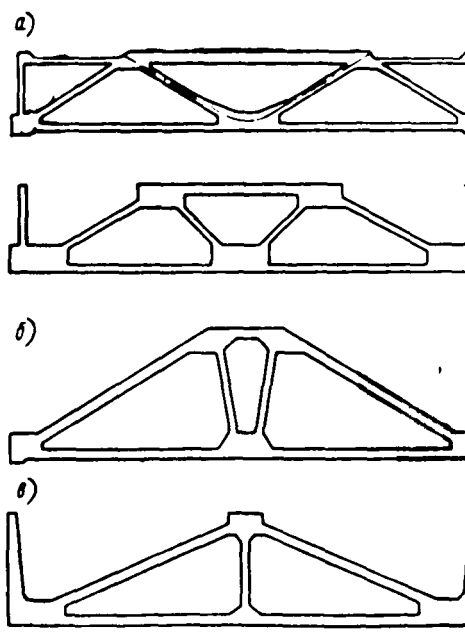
Подстропильные фермы, применяемые в строительстве
